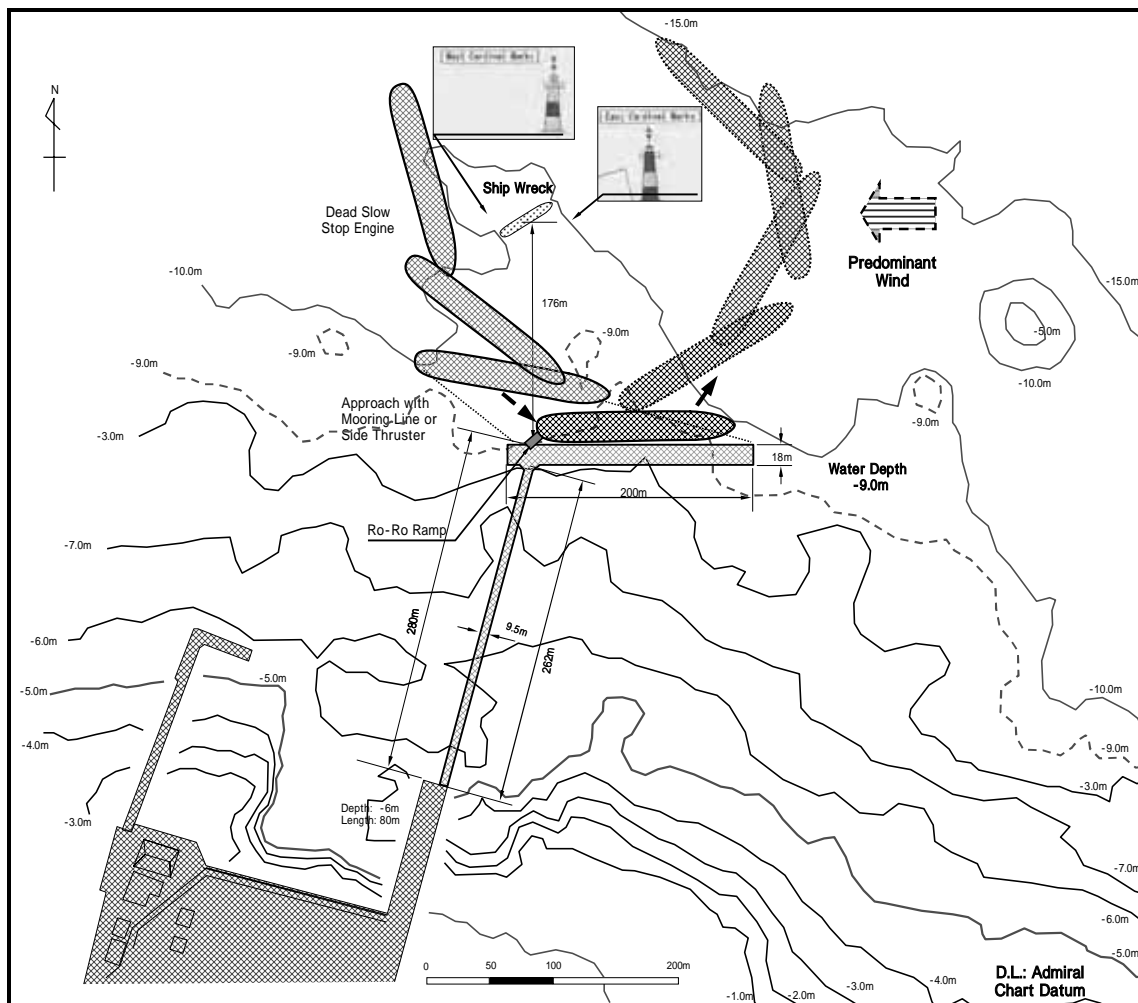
係留棧橋及び連絡橋の平面配置の概要
